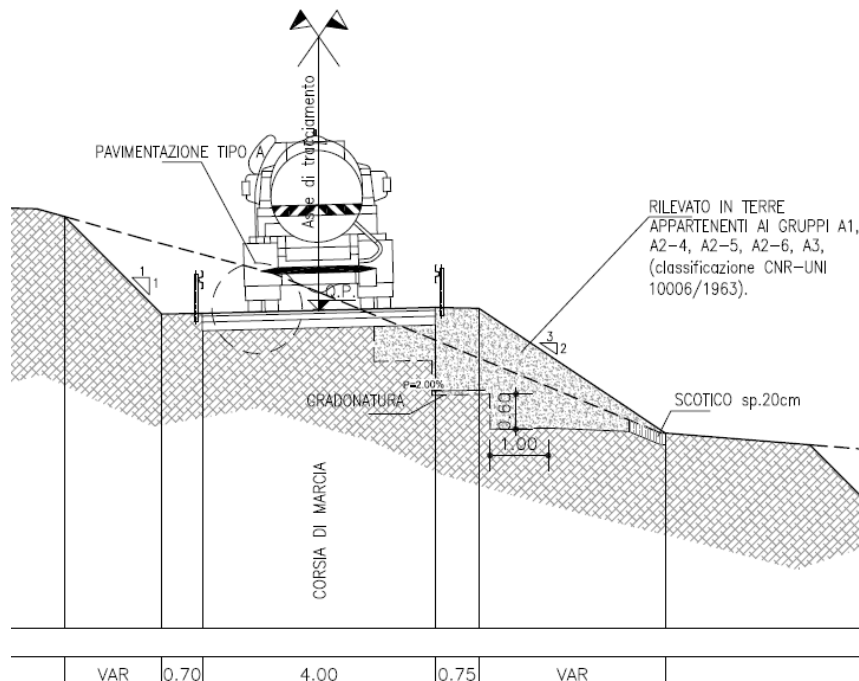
Sezione tipo strada di cantiere/security (mezza costa)
